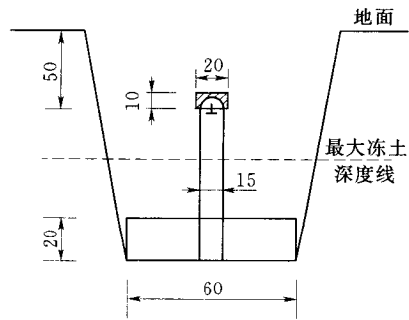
5 - 1 钢筋混凝土柱普通水准标石埋设图 (单位: cm)
